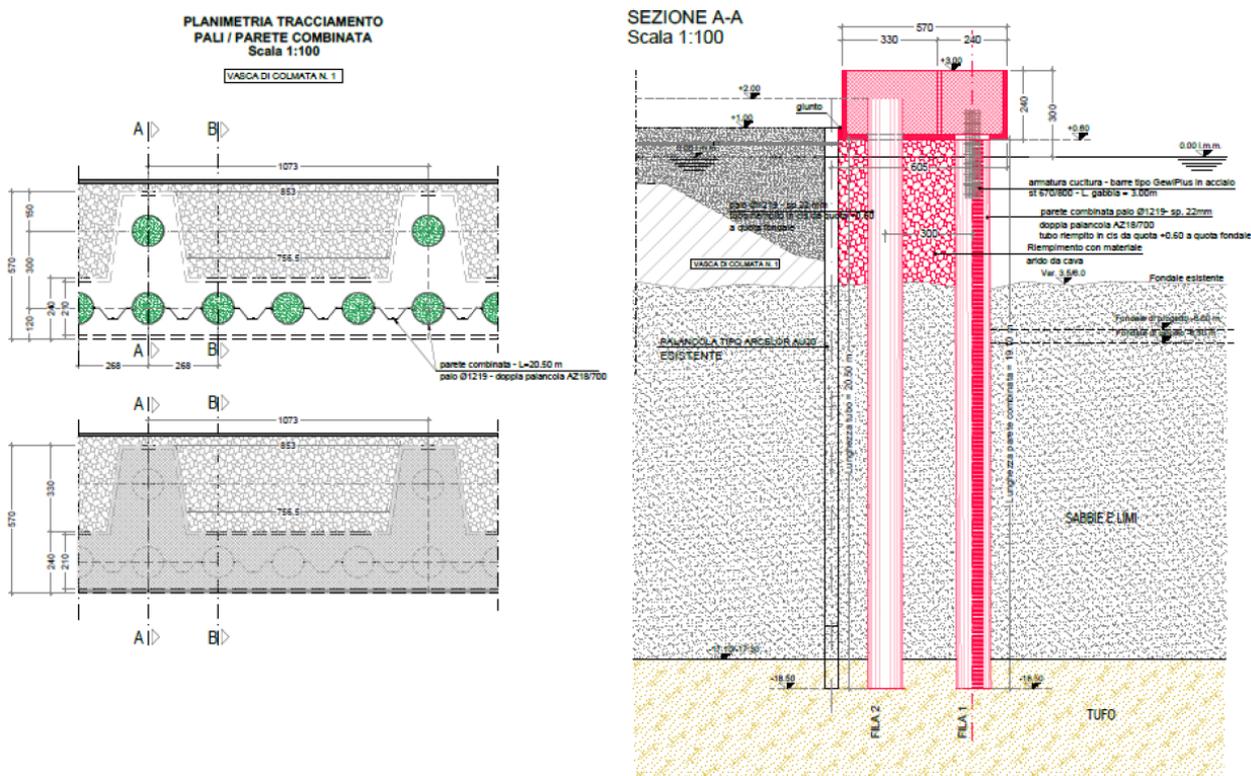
Sezione tipologica di progetto tratto C (stralcio elaborato MI061P-PDDS4022 - Progetto cassa di colmata – Sezioni)
